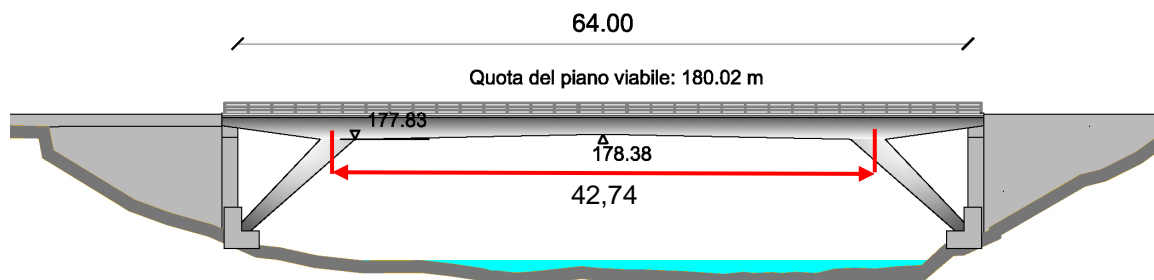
prospetto del nuovo ponte come da soluzione di progetto.
